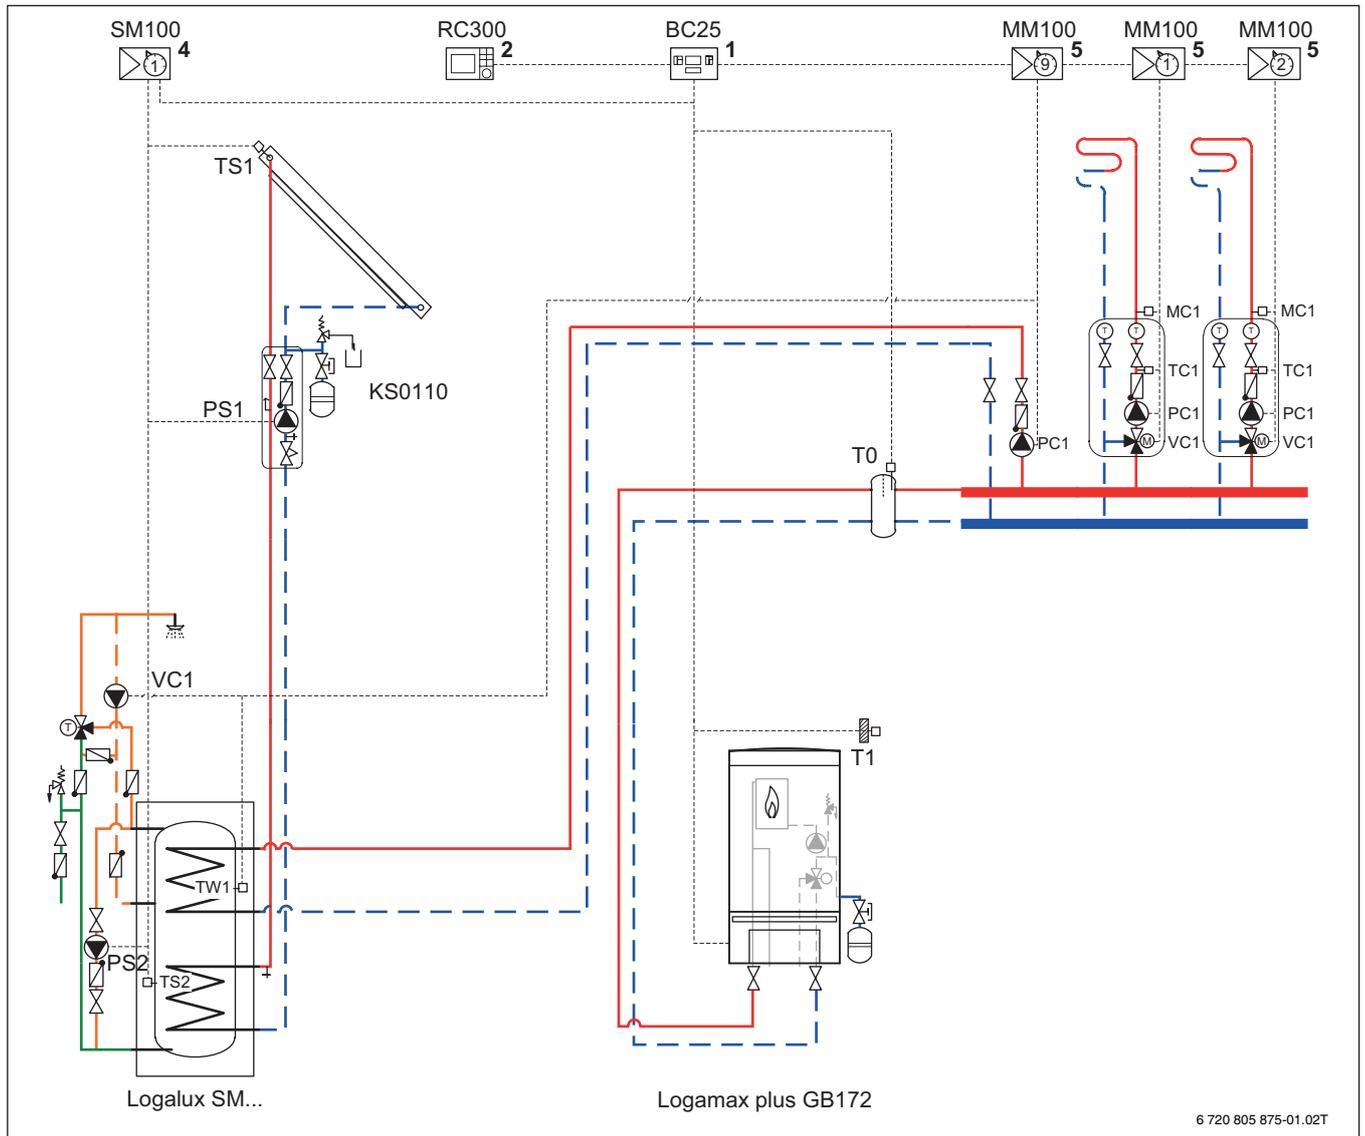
Bodenstehender Wärmeerzeuger mit Logamatic EMS plus, solare Warmwasserbereitung mit Umladepumpe (tägliche Aufheizung Warmwasser 60 °C)
